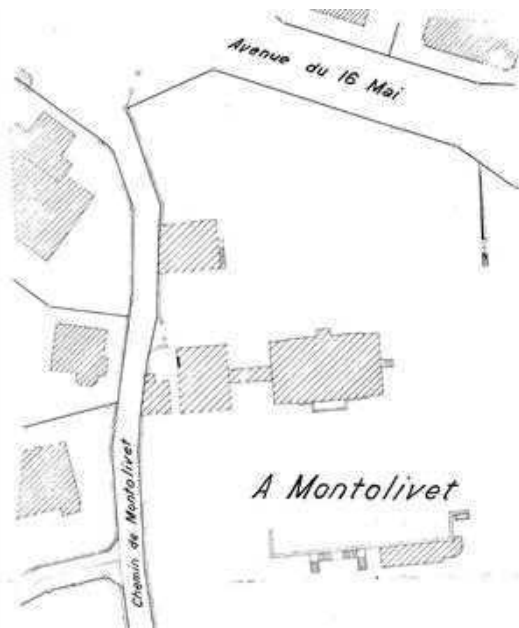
Plan de situation dressé pour enquête le 24 août 1943. Ce plan fait apparaître une serre adossée au mur de soutènement au sud. Elle a été détruite par un incendie en 1947. A proximité, au nord-est, est installé un bassin ou une fontaine.
